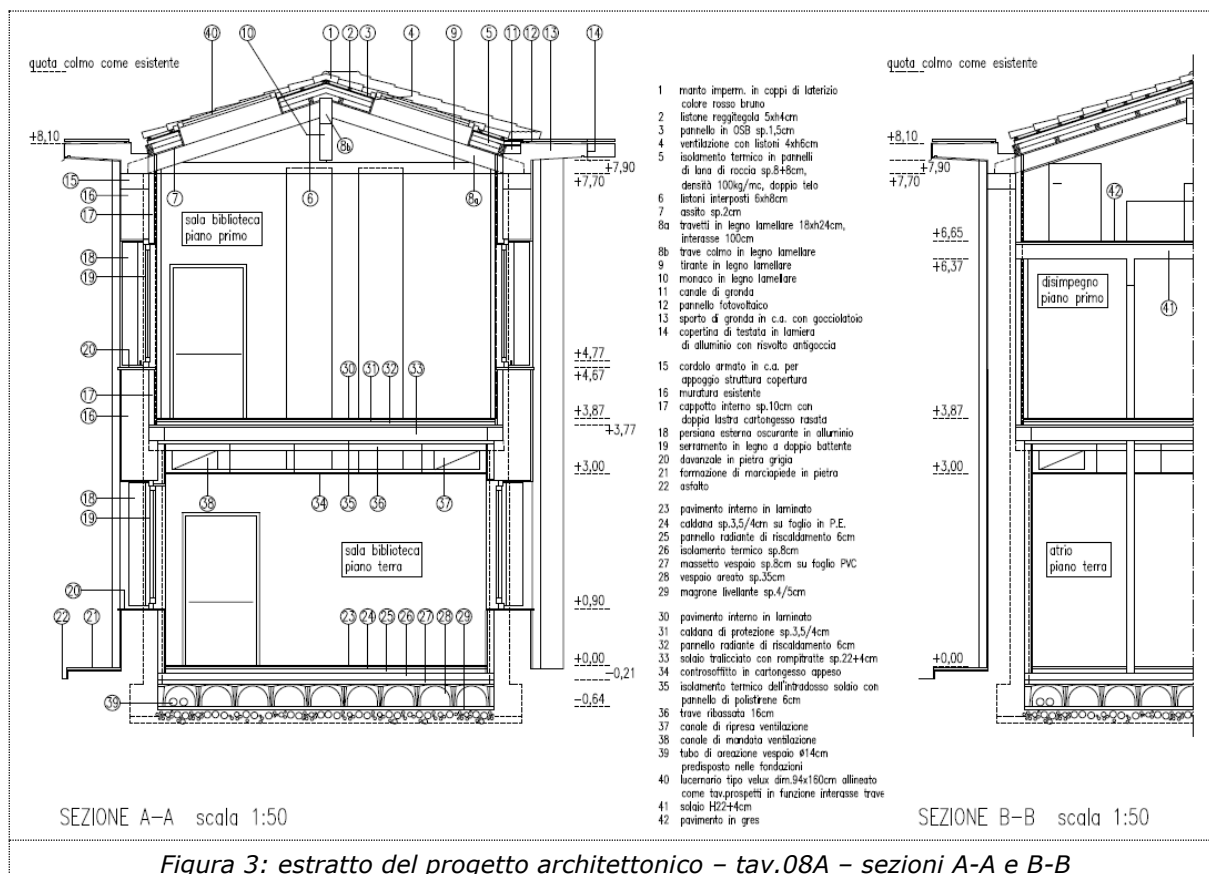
estratto del progetto architettonico – tav.08A – sezioni A-A e B-B
